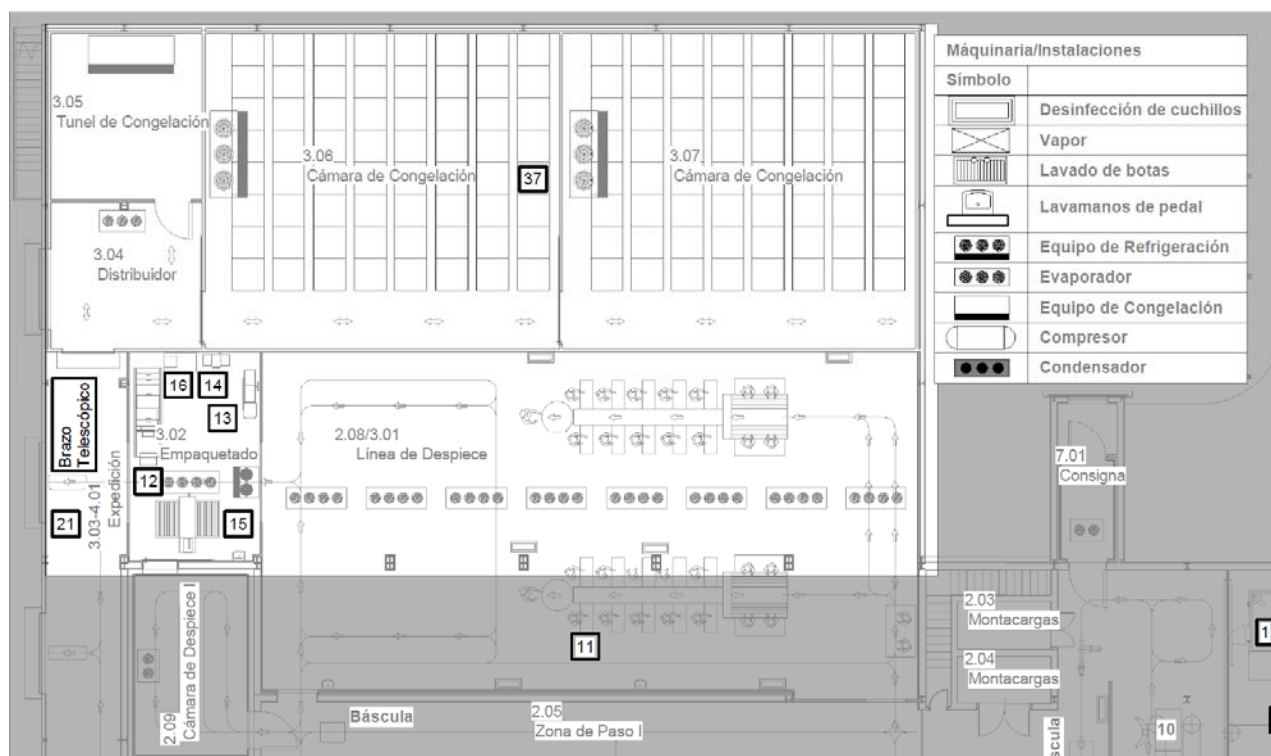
Distribución de Maquinaria: Nave 3 (Planta Baja).
